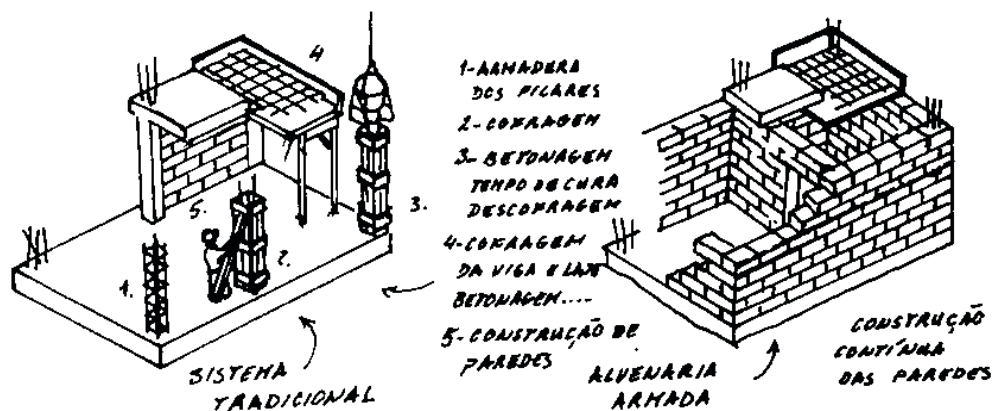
Sistema de construção de alvenaria de blocos de betão tradicional e alvenaria. (Mascarenhas, 2004, p. 89).
